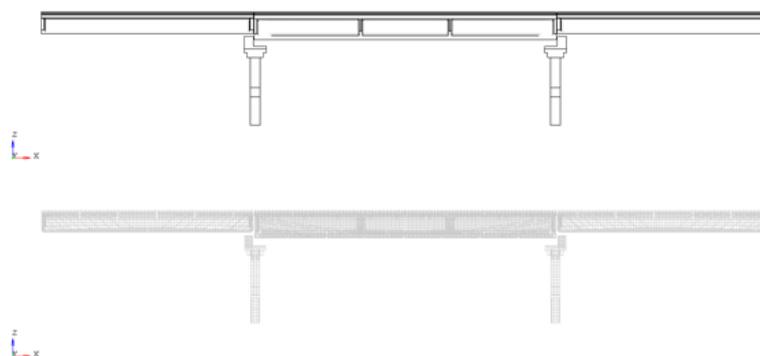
Деформируемая конечно-элементная модель путепровода. Модели железобетонных элементов конструкции: сверху – бетон, снизу – армирующие конструкции
